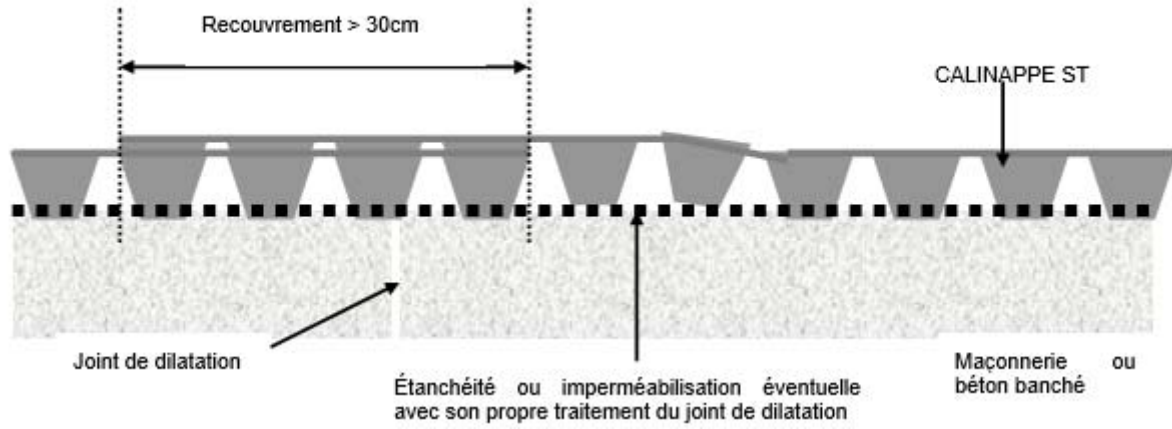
Traitement au passage du droit du joint de dilatation – Recouvrement du dernier lé (coupe horizontale)
